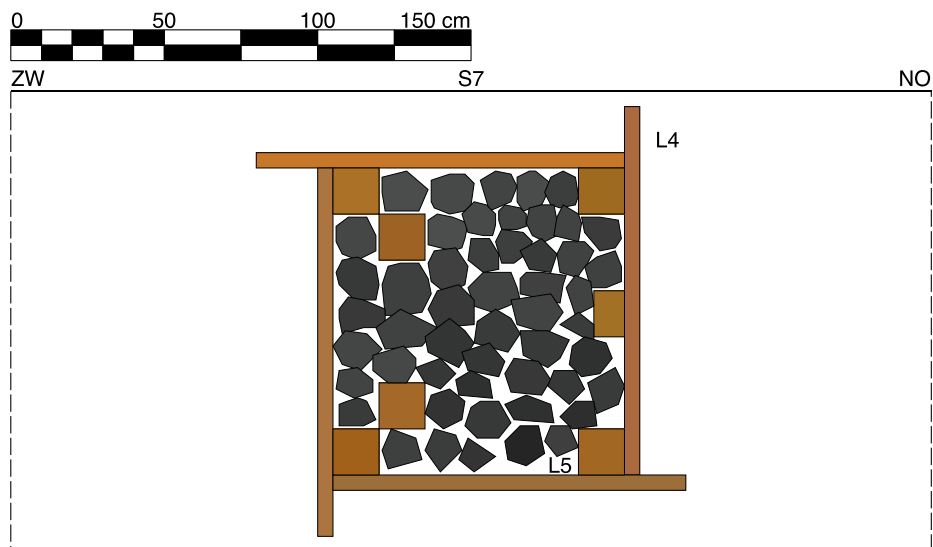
Bovenaanzicht schachtconstructie S7.
